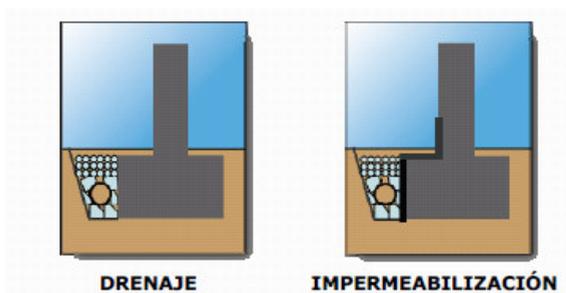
Drenaje e impermeabilización (Fuente: Apuntes Construcción VI)
